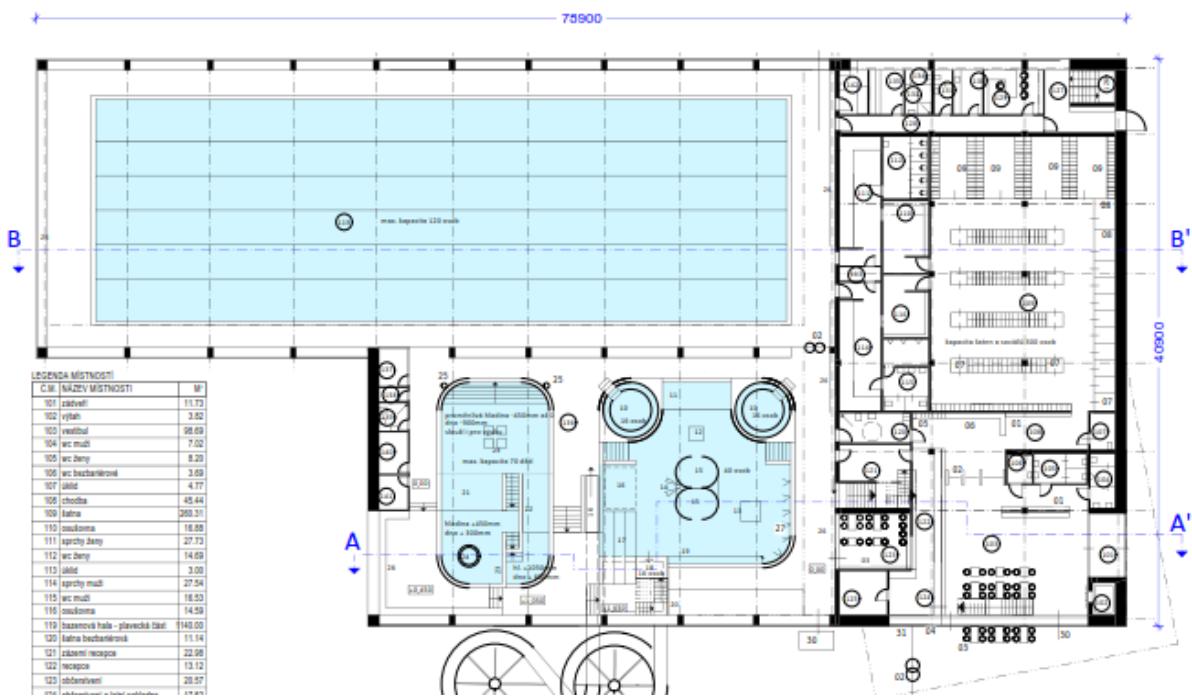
Situace areálu – 25 m bazén (zdroj: Šumavaplan projekt s.r.o.)
